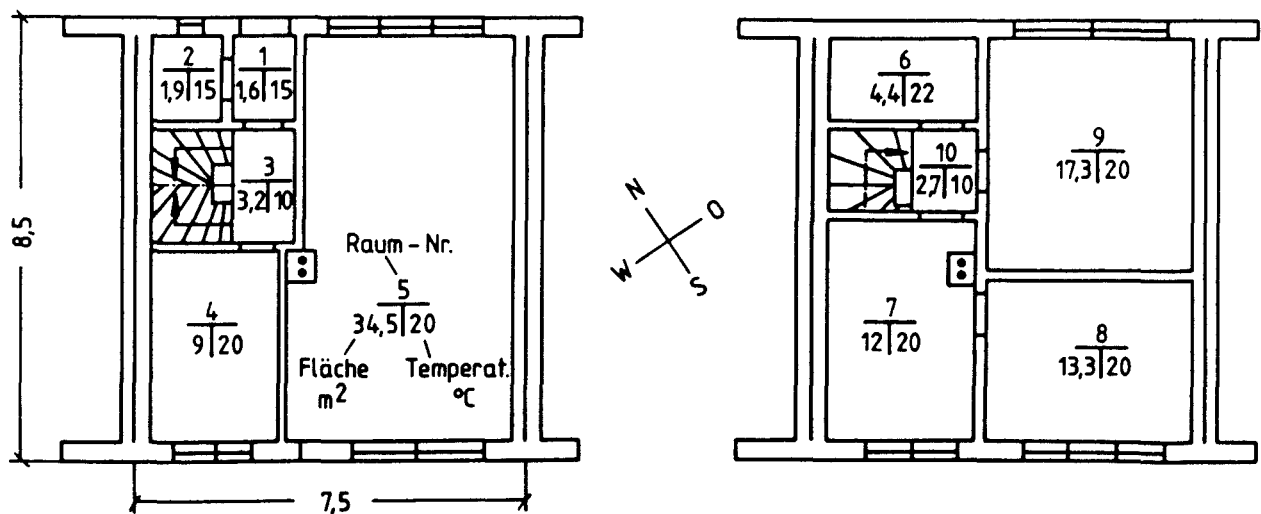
Grundriß (M 1:100) des Einfamilien-Reihenhauses (Flachdach)
